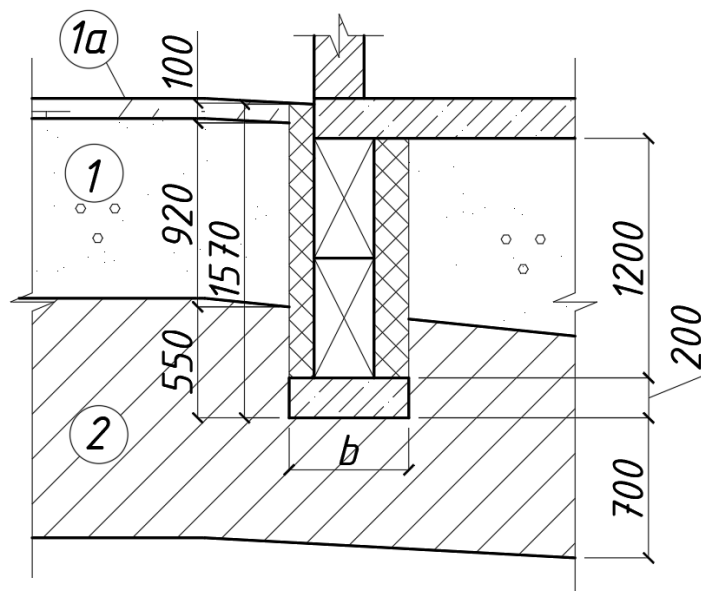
Розрахункова схема фундаменту під зовнішні стіни.
